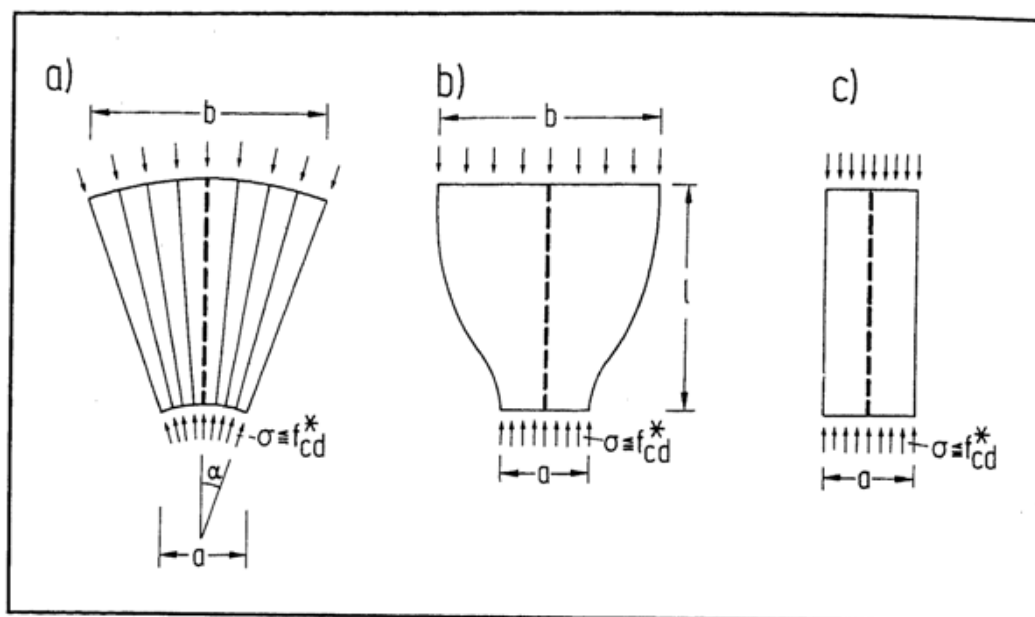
Campos de compressão: (a) leque; (b) garrafa; (c) prismático [3]
